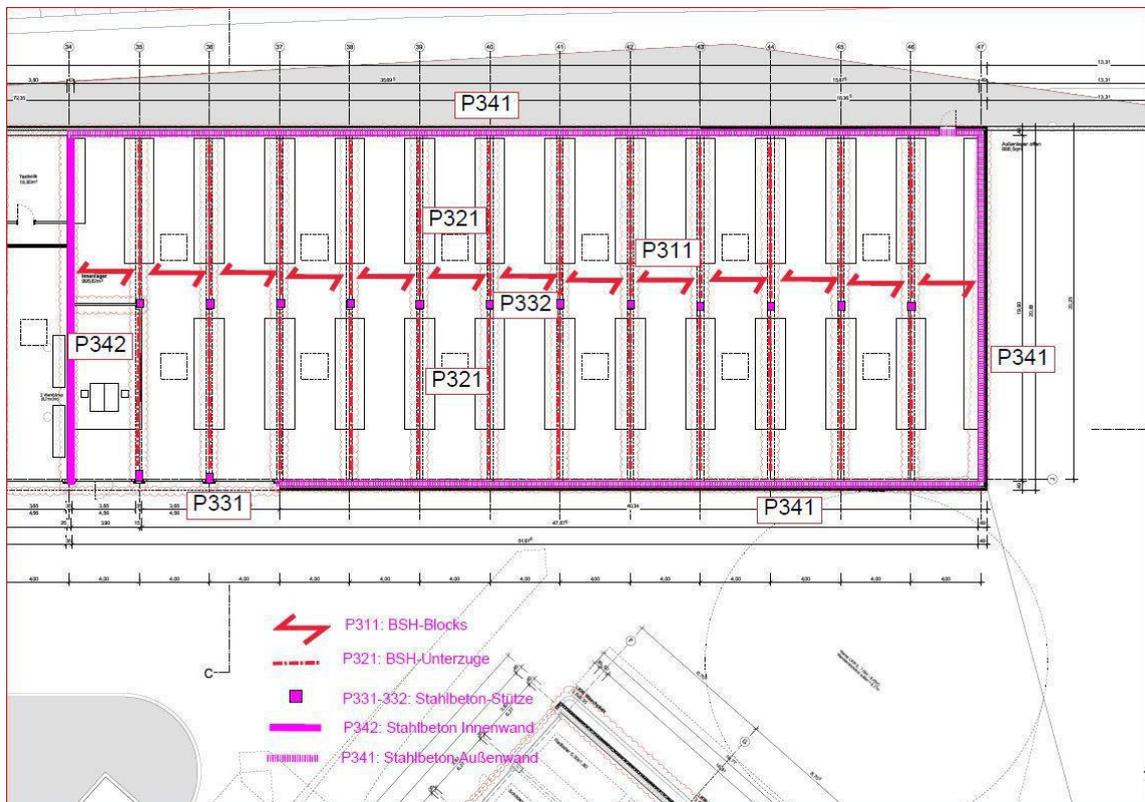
Positionsplan des Lagers (B3) im EG
